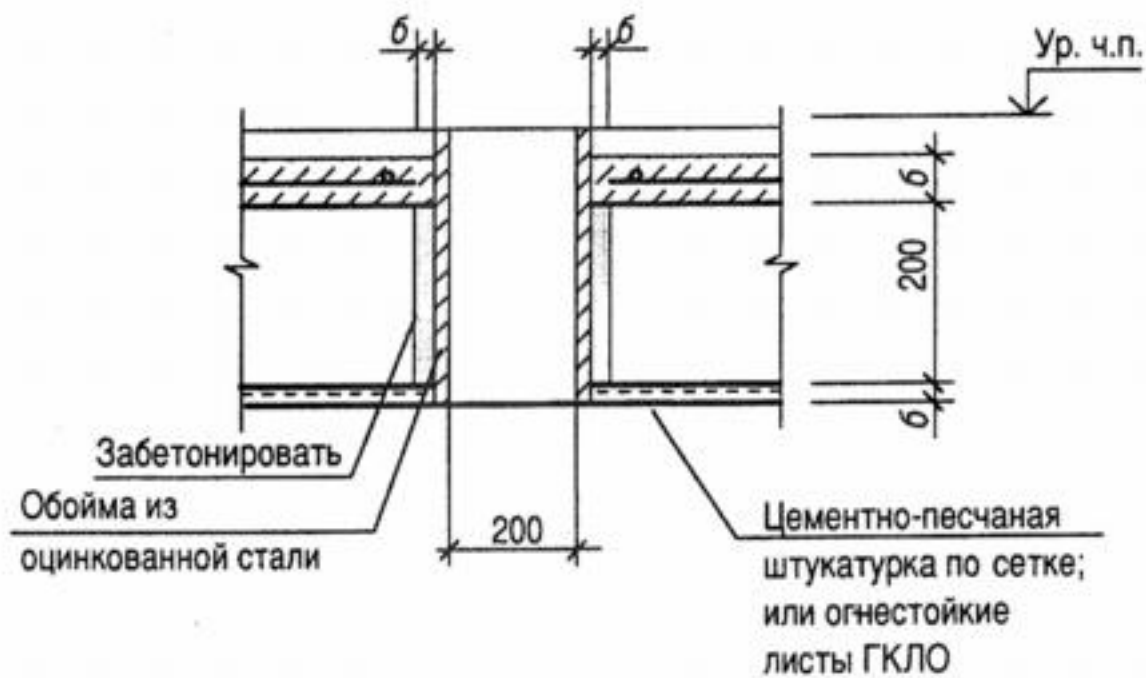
Пропуск вентиляционных каналов через перекрытие
